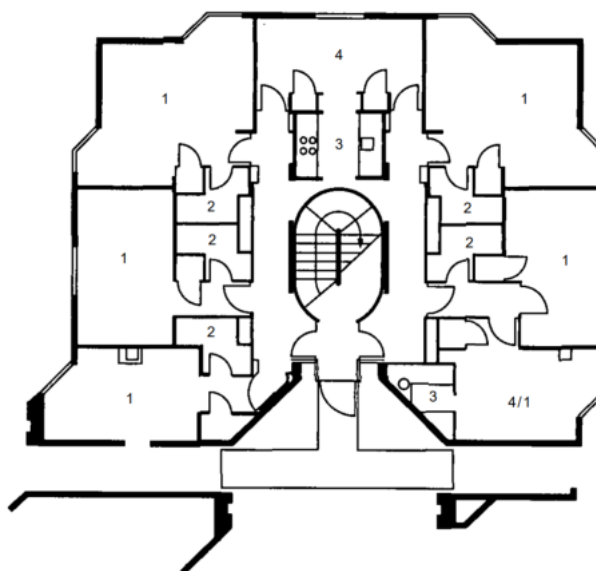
Planta do Pavimento Térreo. Balliol College, Reino Unido
